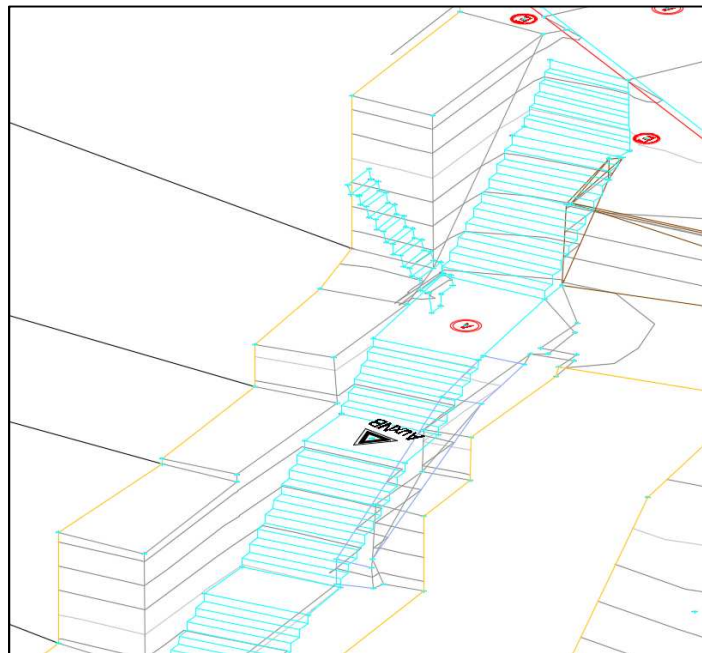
Esquema levantamiento topográfico de detalle (escaleras, anden y paramento)
